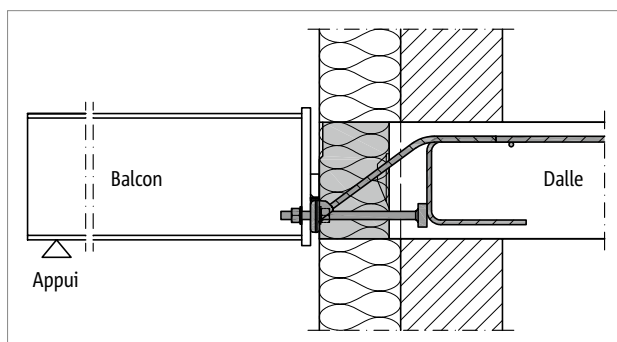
Schöck Isokorb® XT type SQ : Le corps isolant affleure le nu extérieur de l'isolation du mur grâce à la saillie de la dalle vers l'extérieur. Ce faisant, les distances aux bords latéraux doivent être respectées
